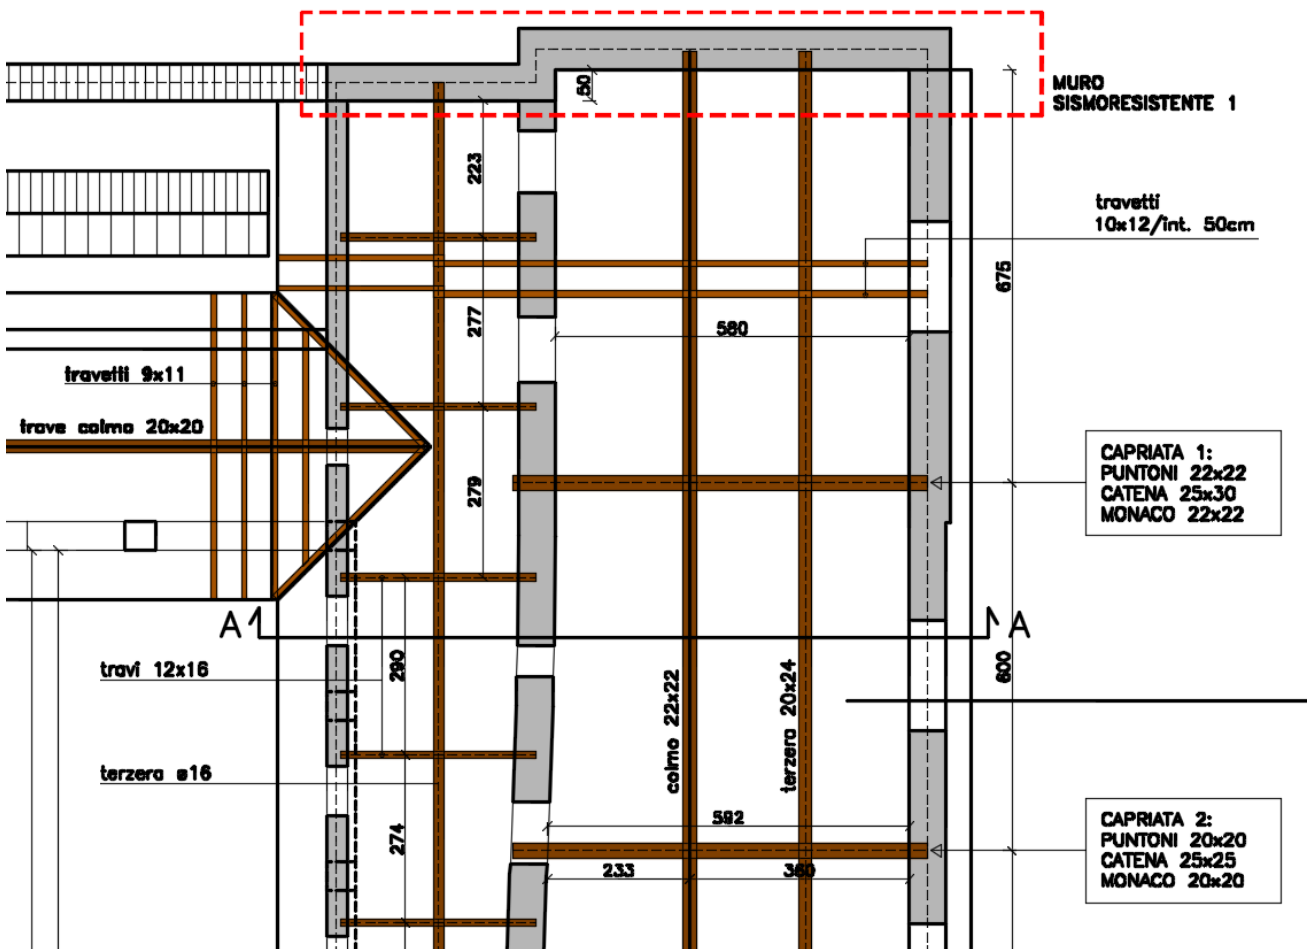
Pianta strutturale di porzione significativa delle strutture di copertura della zona A per individuazione degli elementi sottoposti a verifica
